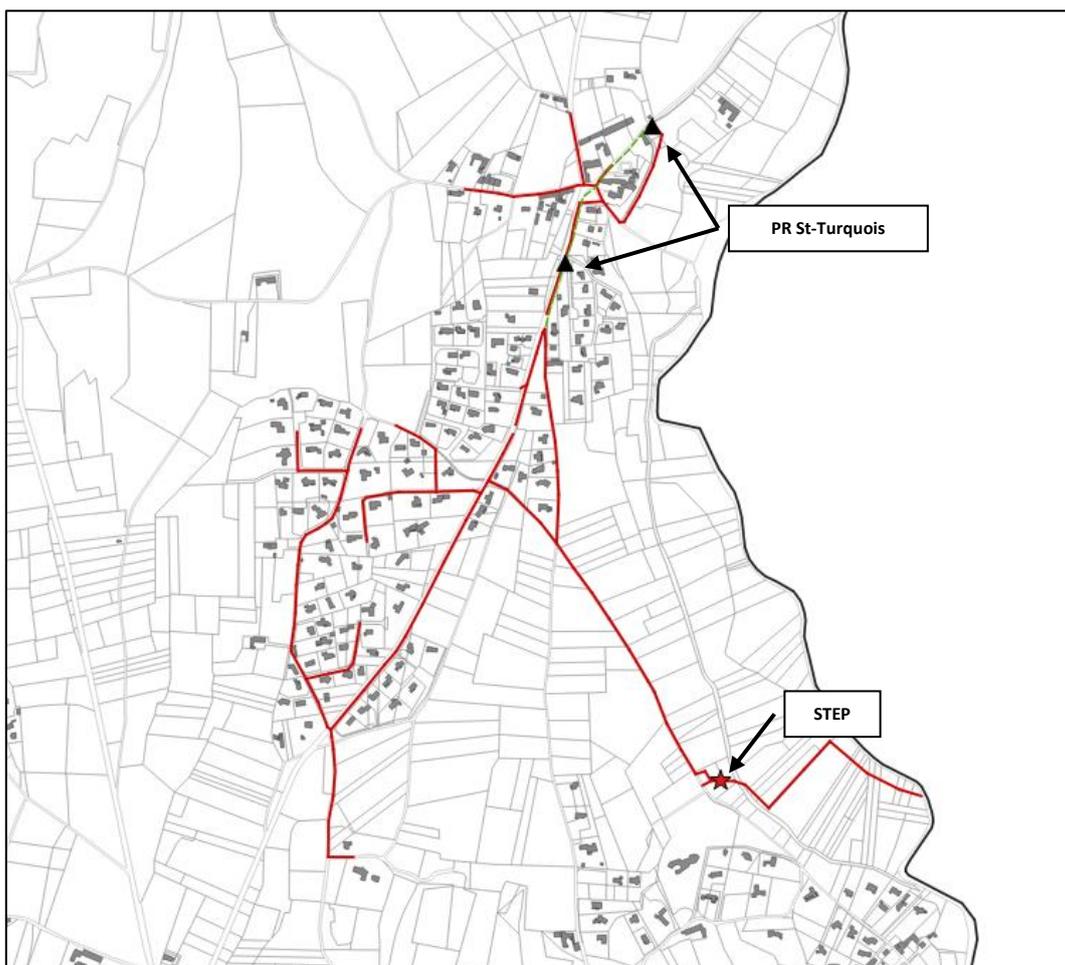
Plan du système d'assainissement de Saint-Turquois
